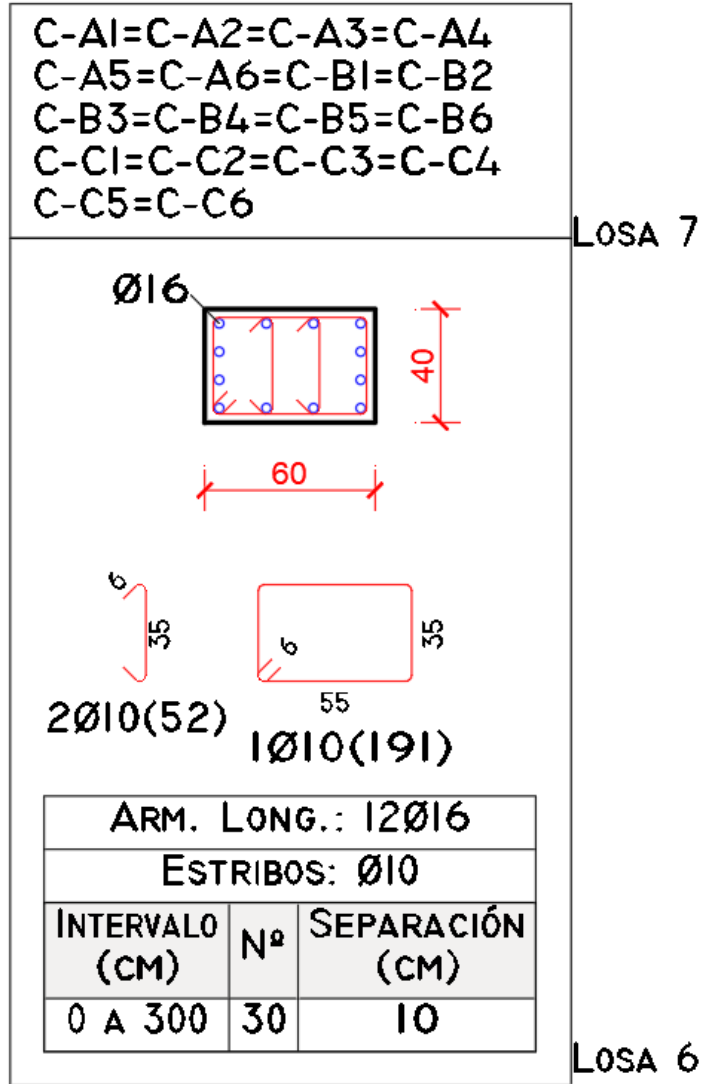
Detalle de Refuerzo Columnas, de Losa 6 a Losa 7, Estructura [7N-EE].
